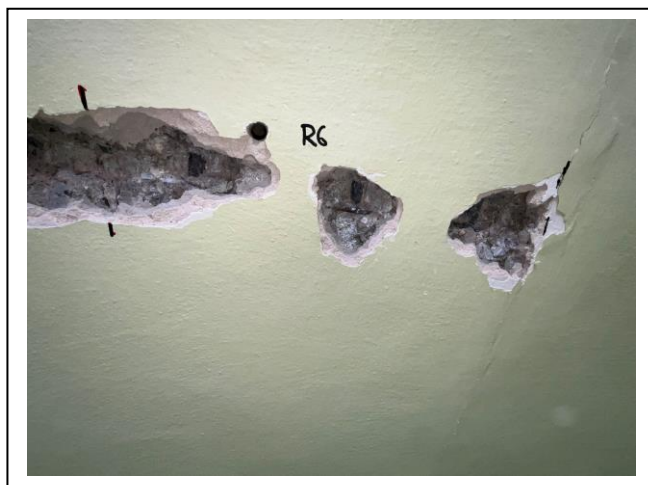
R6, R7 – stropní panelFoto 027 – R6 – stropní panelFoto 029 – R6 – stropní panel
